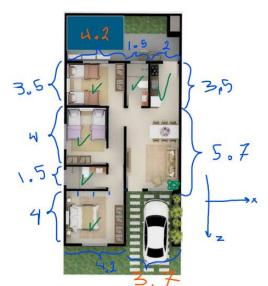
(Ingeniería Civil y Arquitectura, 2021)
